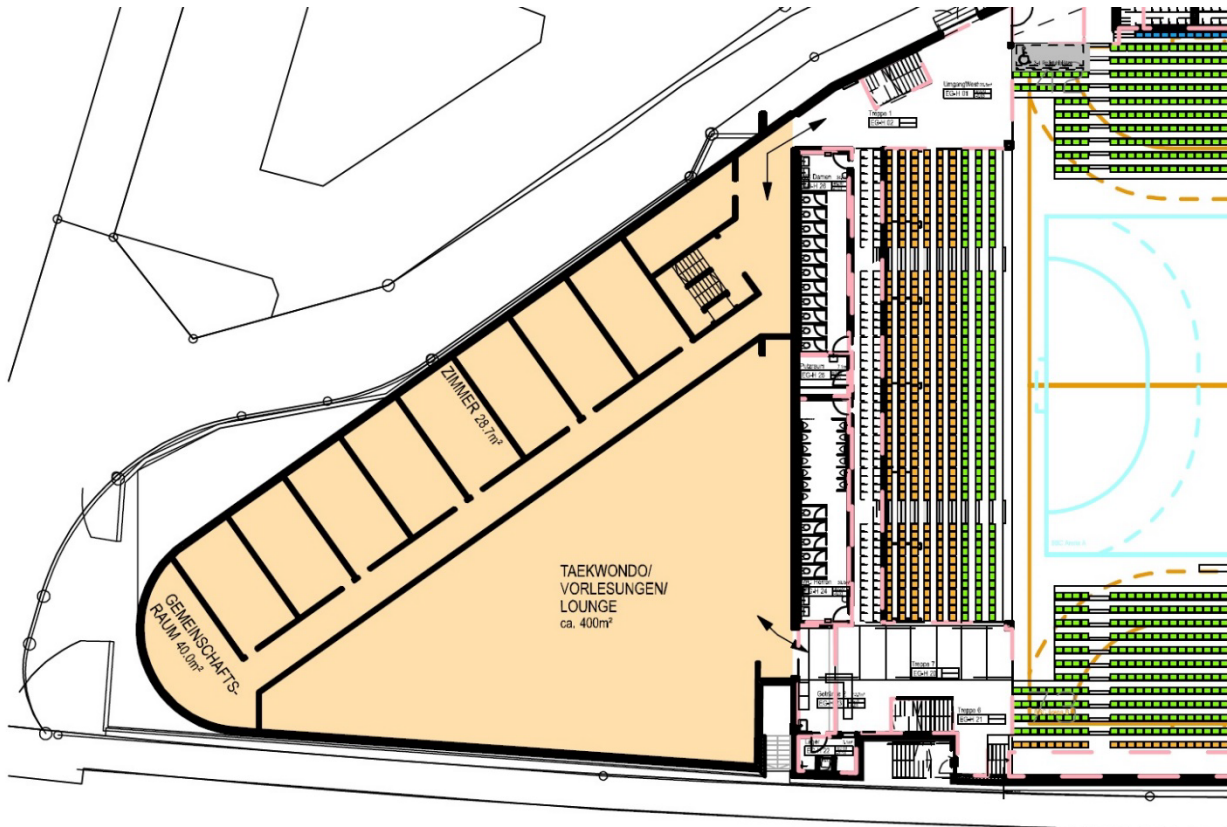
Grundriss Erdgeschoss Anbau West
